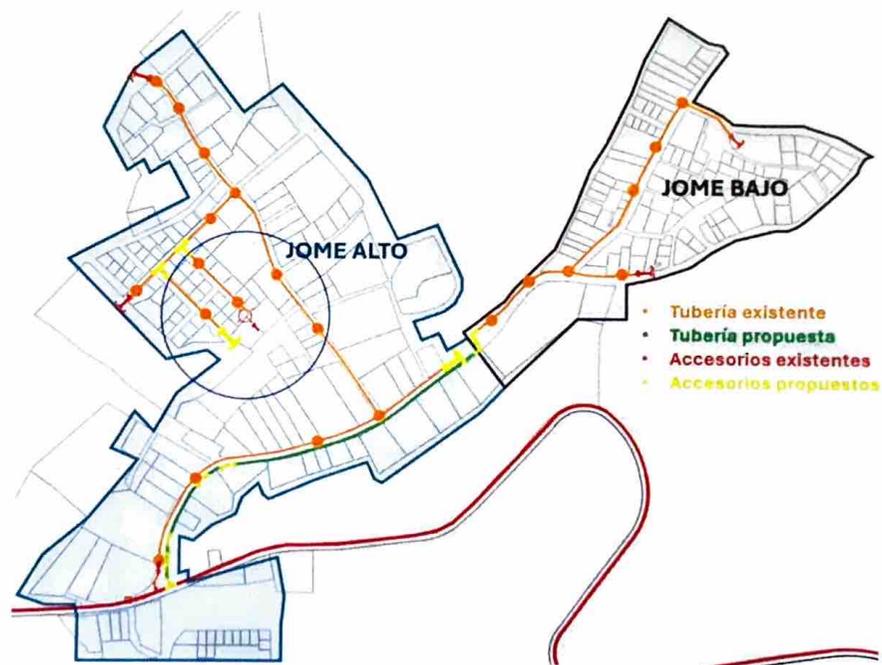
Tubería paralela de refuerzo propuesta y accesorios en Jome
